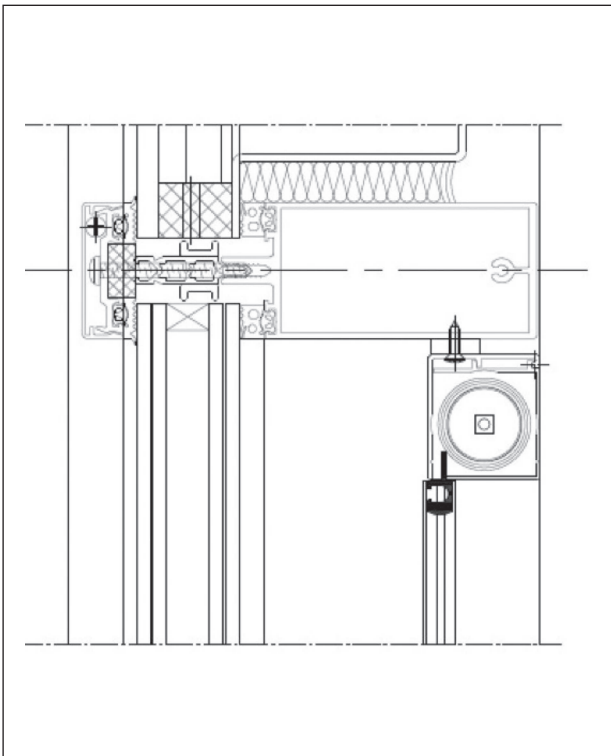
Pfosten-Riegel-Montage mit eckiger Kassette, Einbau unter dem
